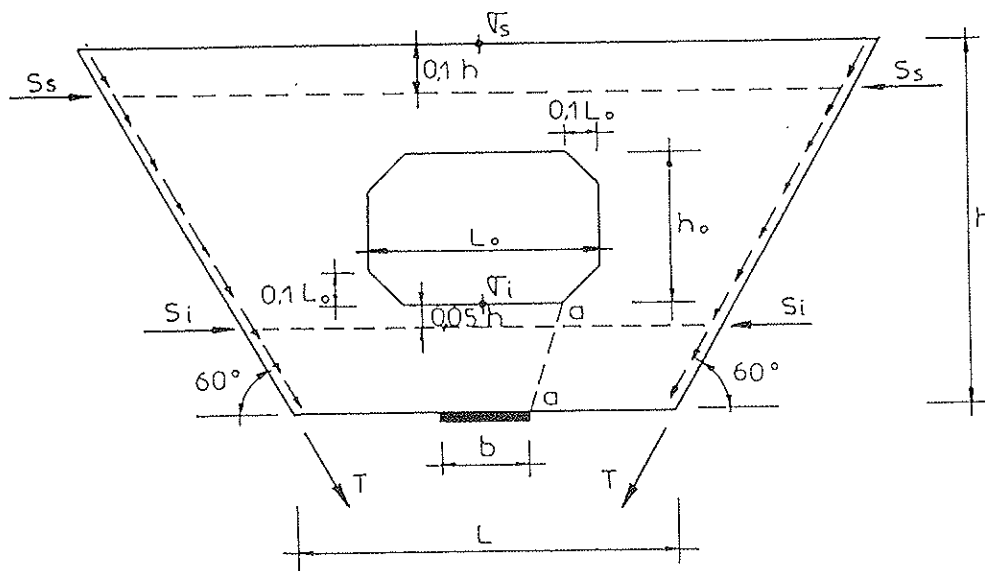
Detalle de viga transversal de una sección cajón y cargas actuantes.
